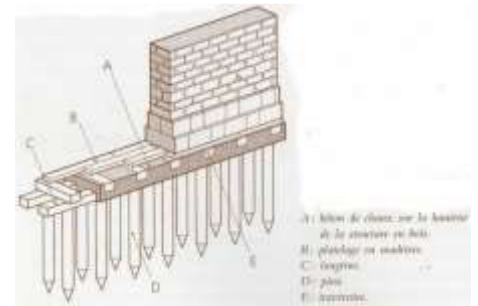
Fondations sur Pieux reliée par longrines.
